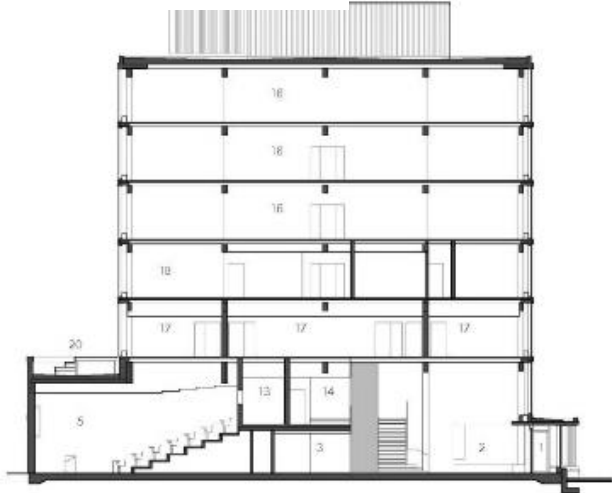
Corte estructural edificio. Revista Architect, 2015.
